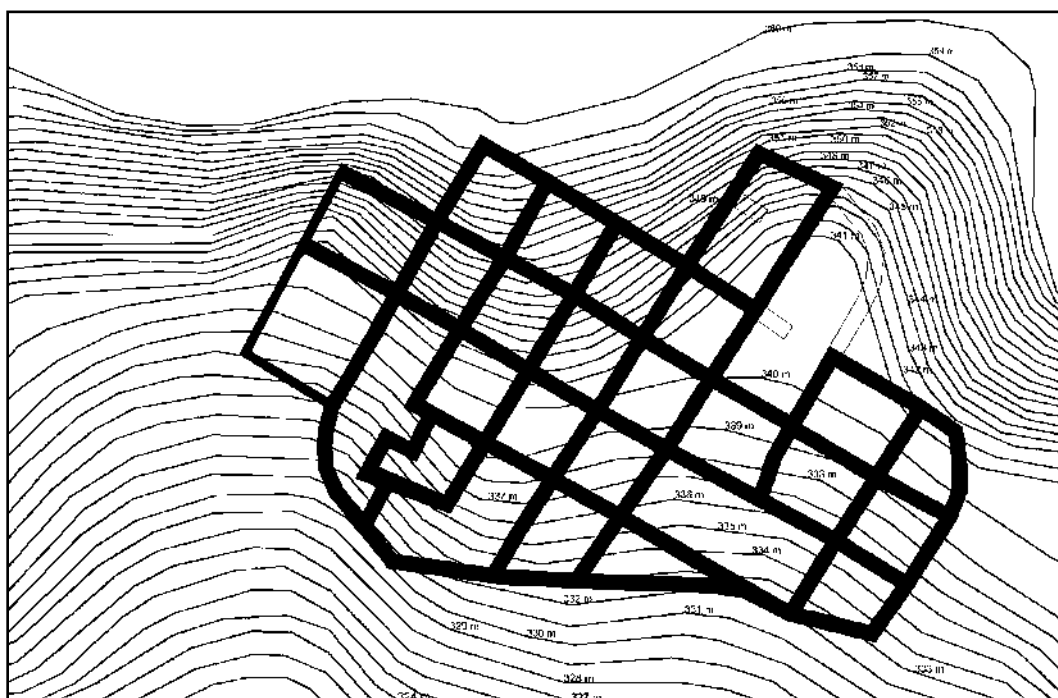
4. Calles con sistema de alcantarillado sanitario.
